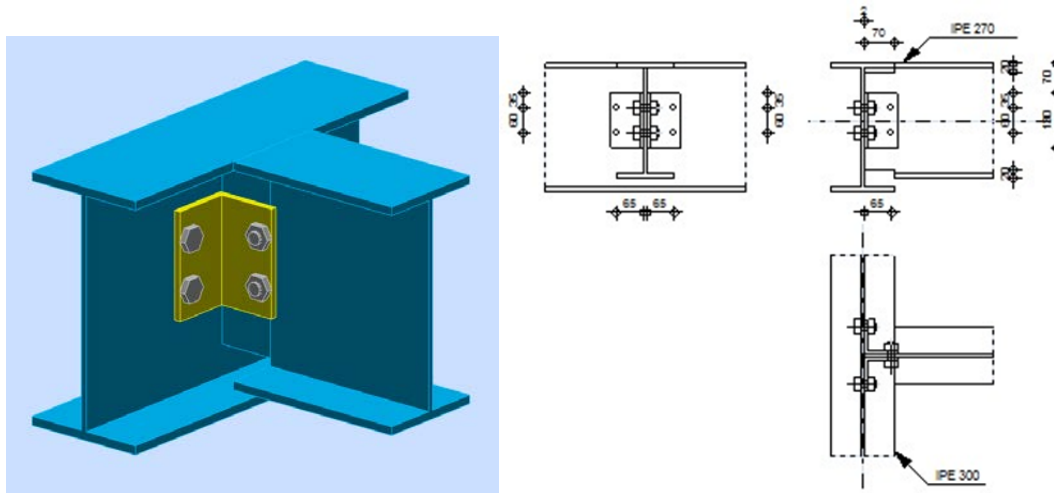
Vista 3D e Pormenores da Ligação Travessa-Viga Interior
